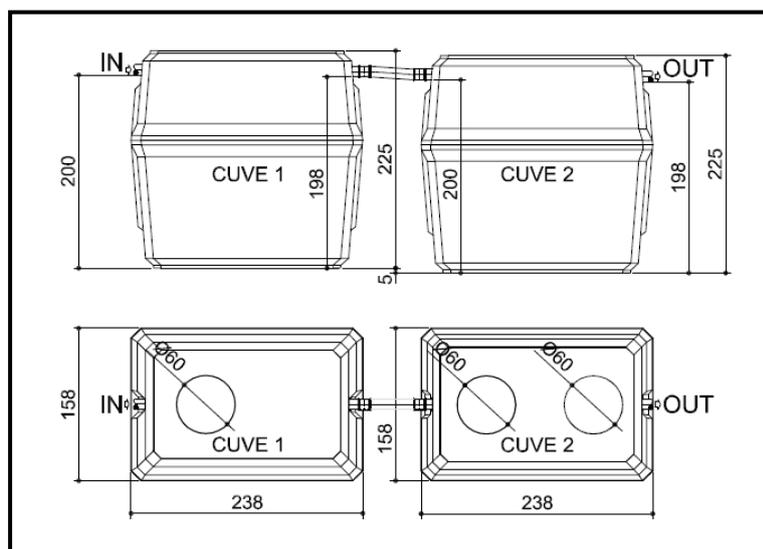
Plan d'encombrement des Oxyfix® C-90 MB 9 EH
